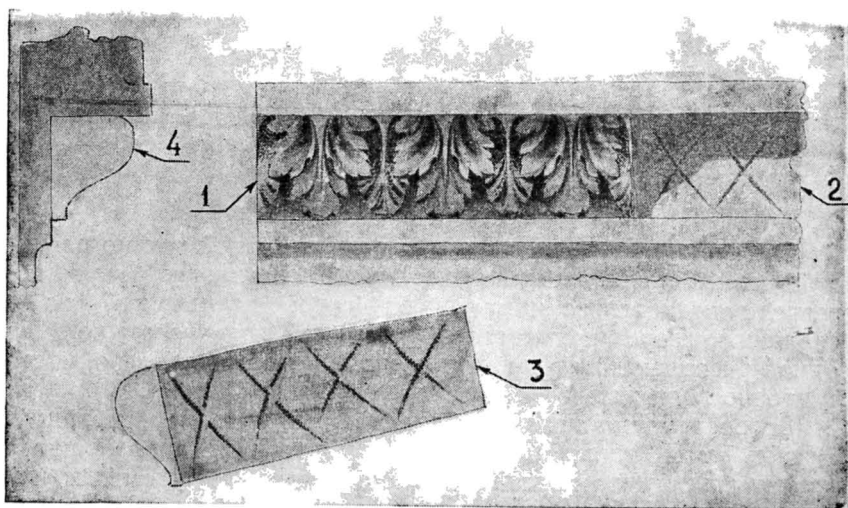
Постановка гипсовой порезки. 1 — укрепленная на штукатурное место порезка, 2 — подготовленное место с насечкой, 3 — подготовленная порезка для постановки, 4 — разрез штукатурной тяги и порезки
